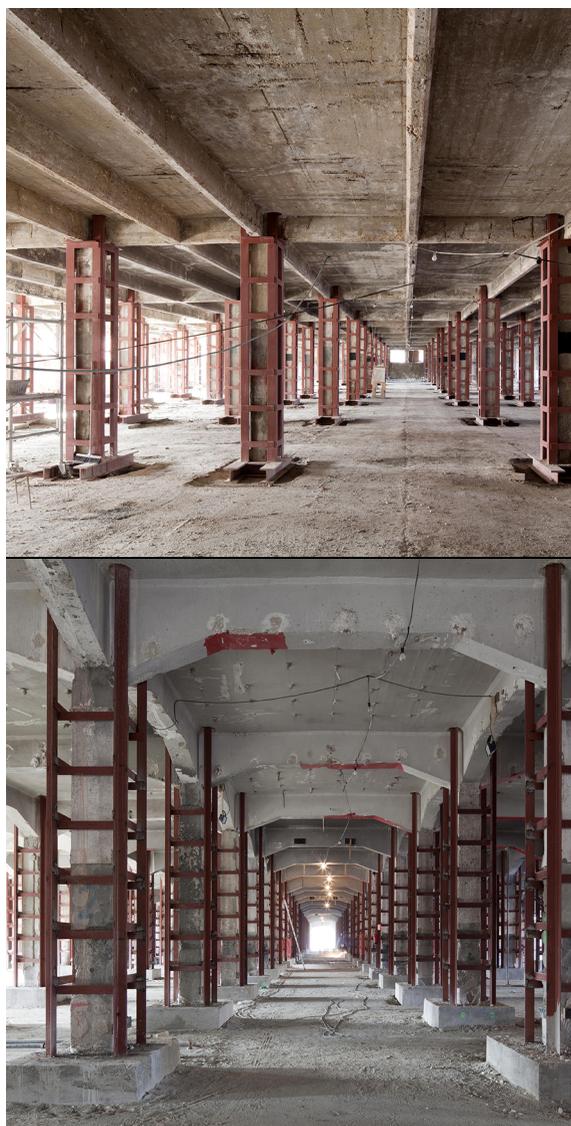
Refuerzo estructural en las naves 8 y 9. (Fuente: del autor, Arturo Franco)
